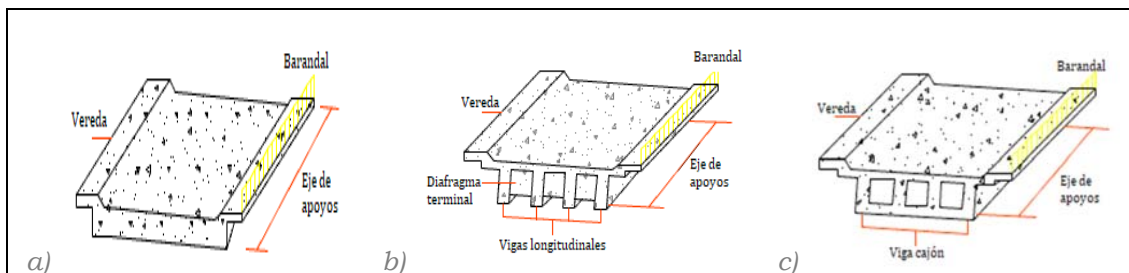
Tipos de cubierta o tableros (a. Losa, b. Losa y vigas, c. Vigas cajón)
